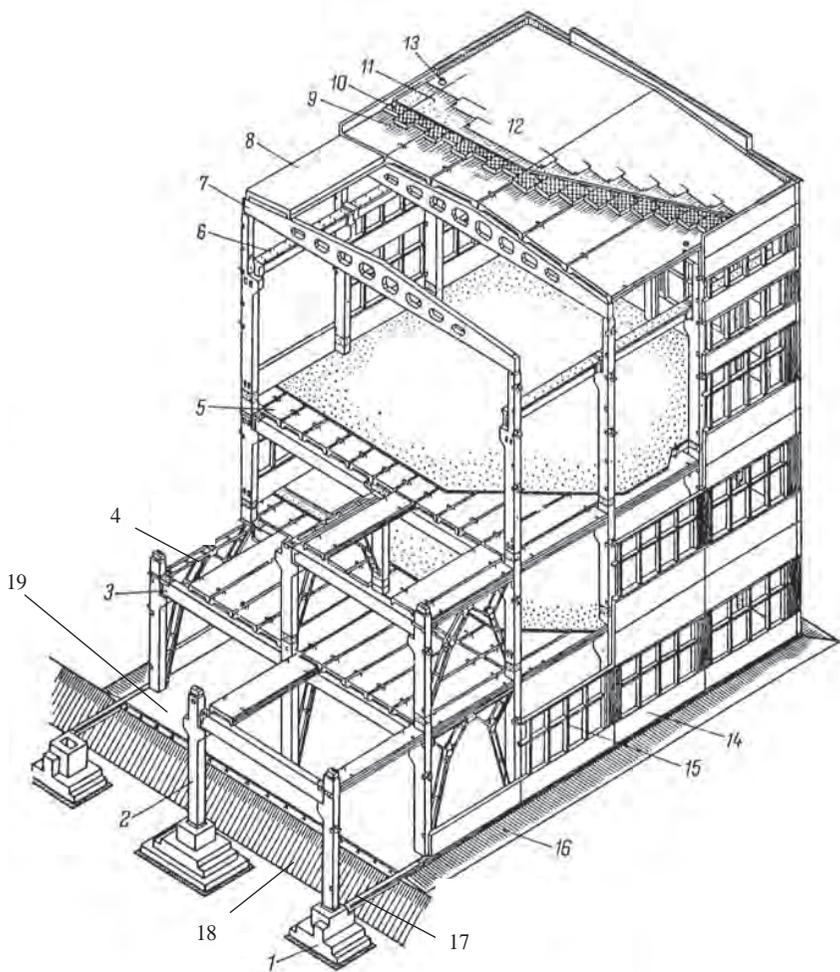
Элементы многоэтажного здания со сборным железобетонным каркасом:
